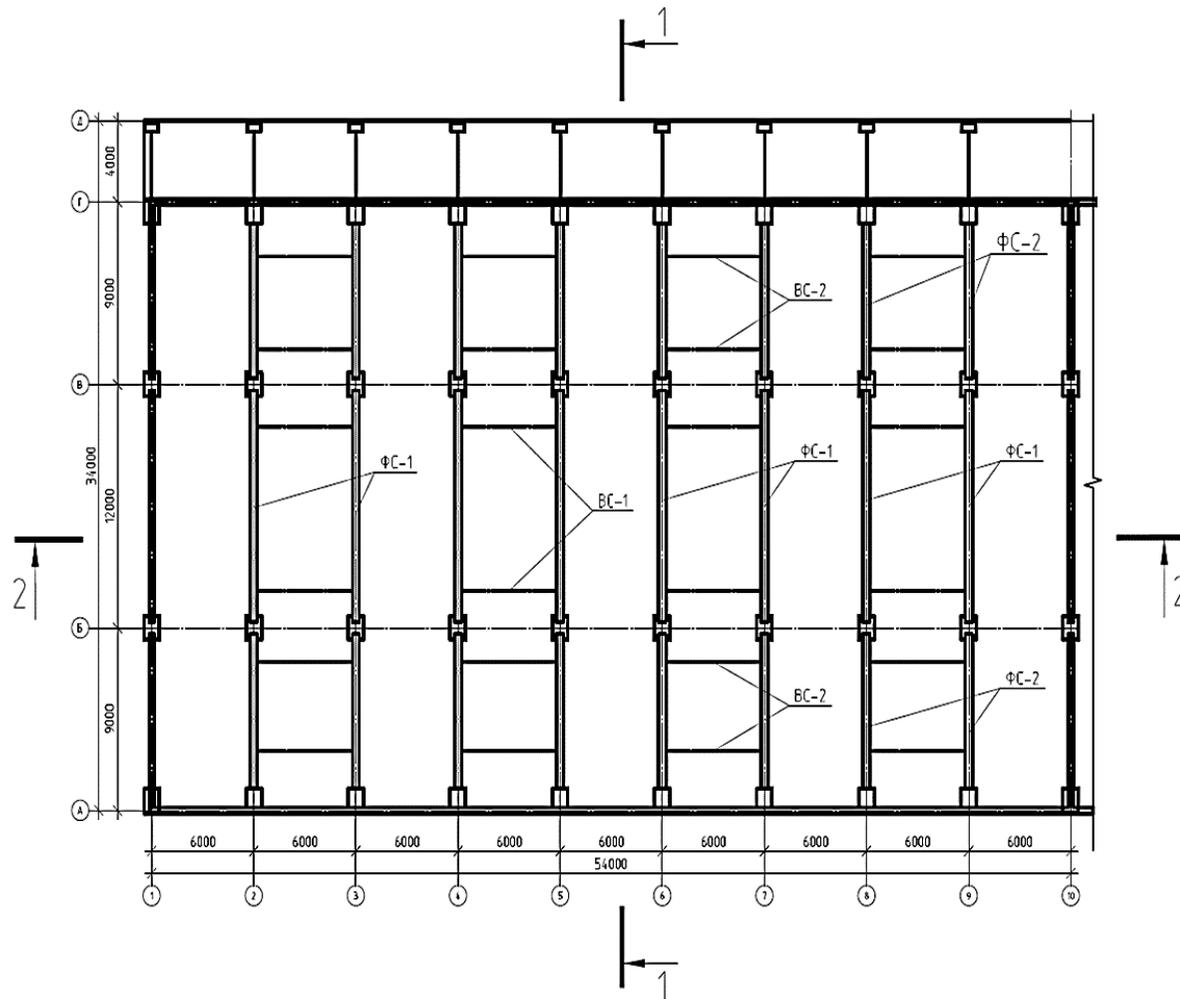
Схема расположения конструкции покрытия в зданиях:
